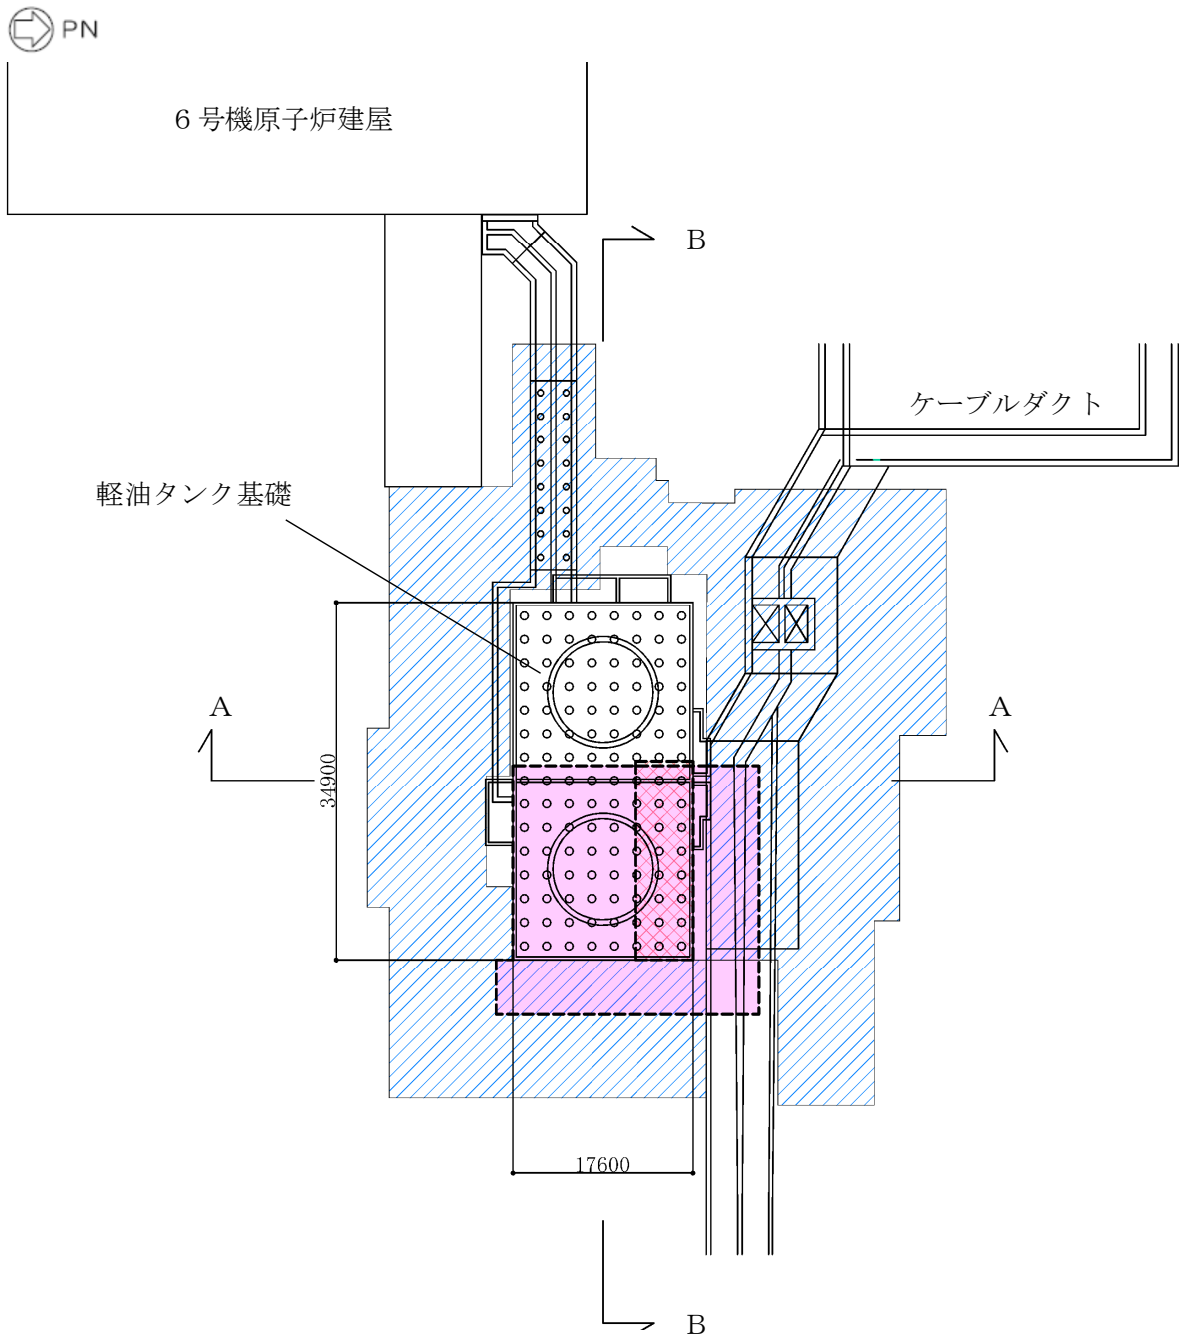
軽油タンク基礎（6号機設備）の平面配置図
